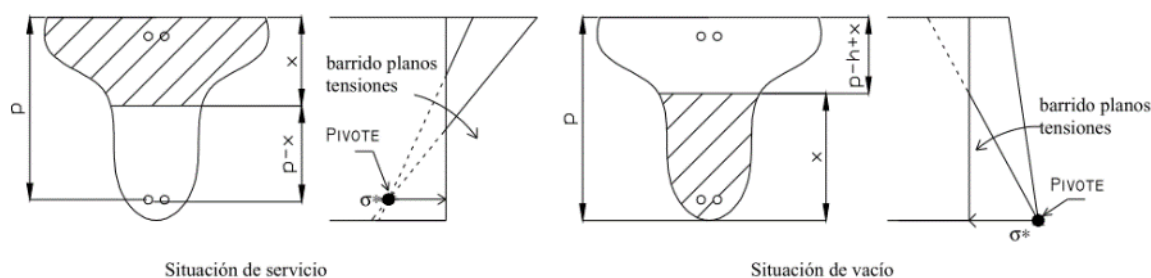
Barrido del Plano de tensiones alrededor de un pivote.
